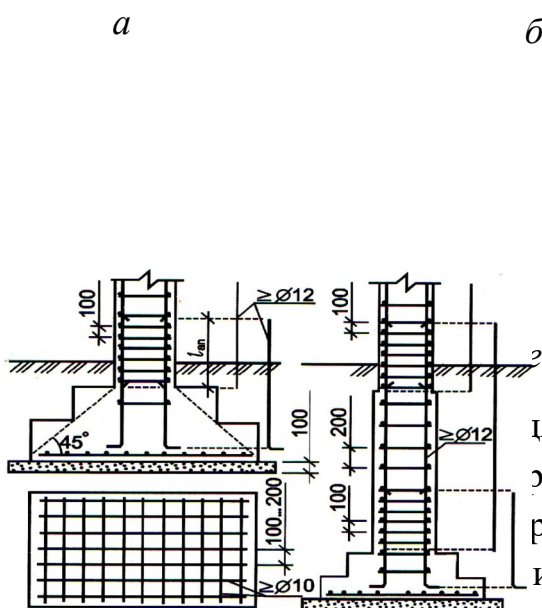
Арматура стовпових залізобетонних фундаментів:
